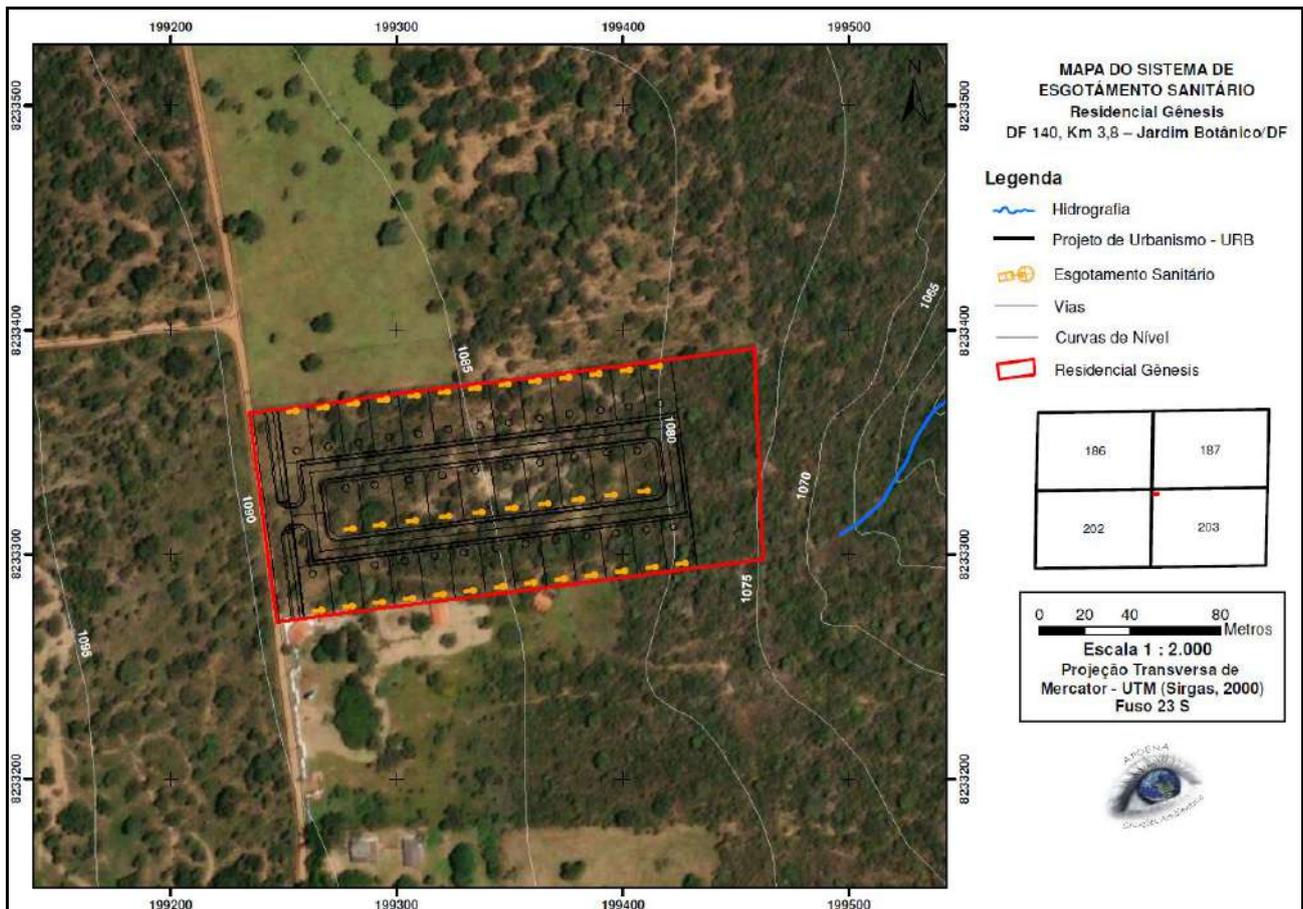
Croqui do sistema de esgotamento sanitário proposto.
